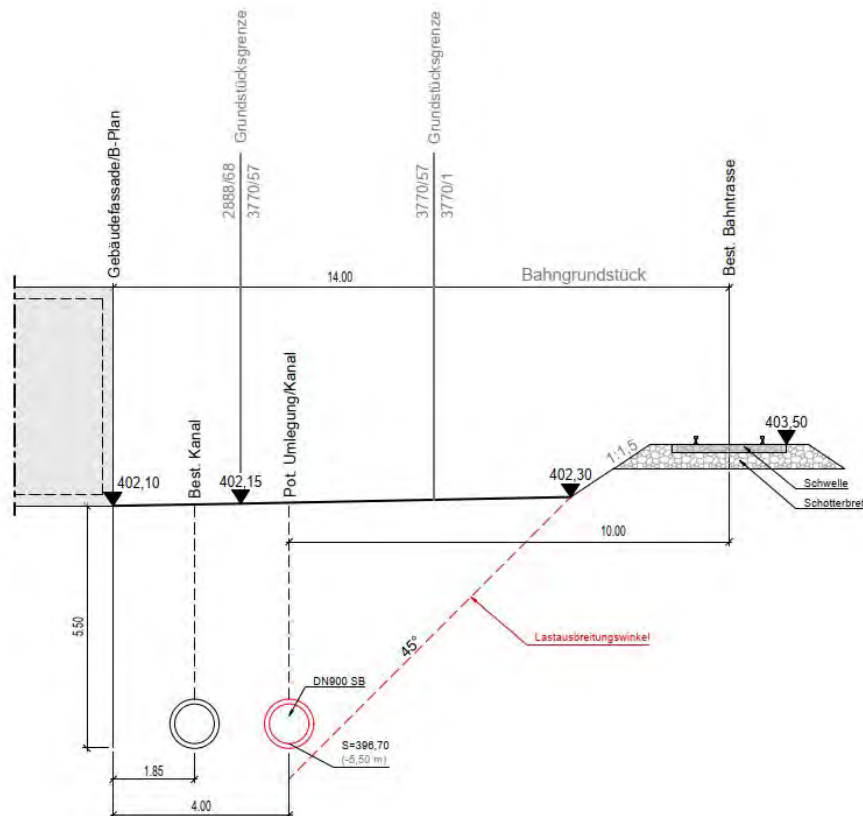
Schnitt – Abstandsprüfung Bebauungsplan zum Bestandskanal (Breinlinger Ingenieure)
